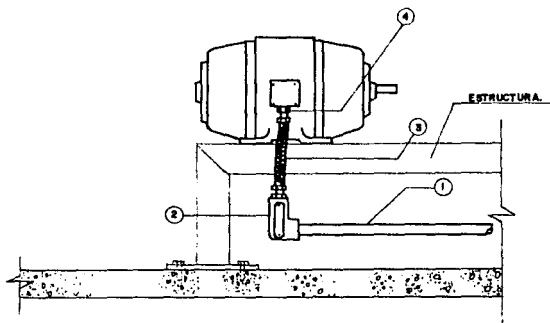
DETALLE DE REMATE A MOTOR CON COMPONENTES
